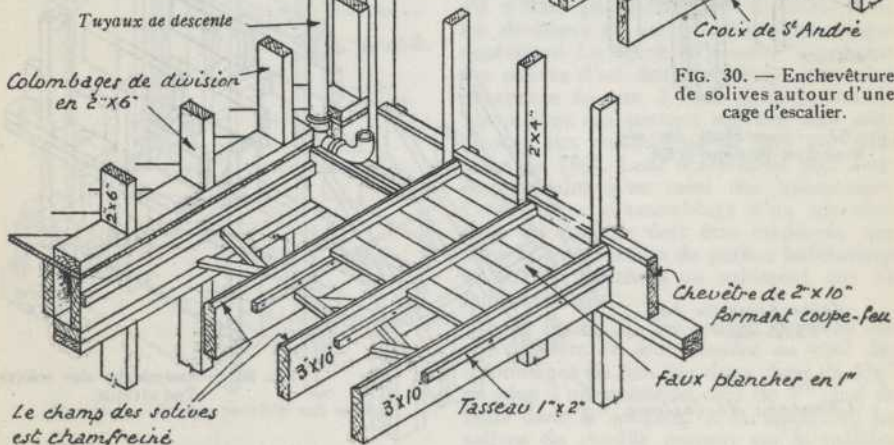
Plancher pour salle de bain finie en tuiles.
